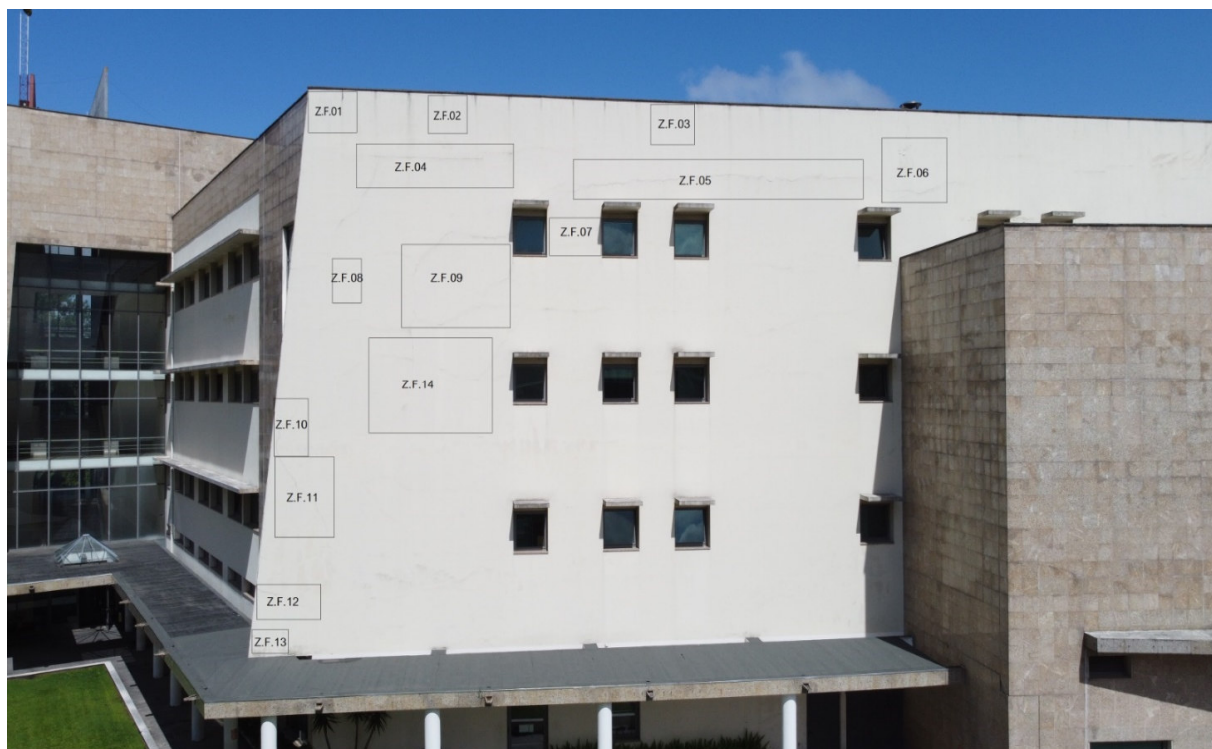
Zonas de Fissura (Z.F.) da fachada em estudo
